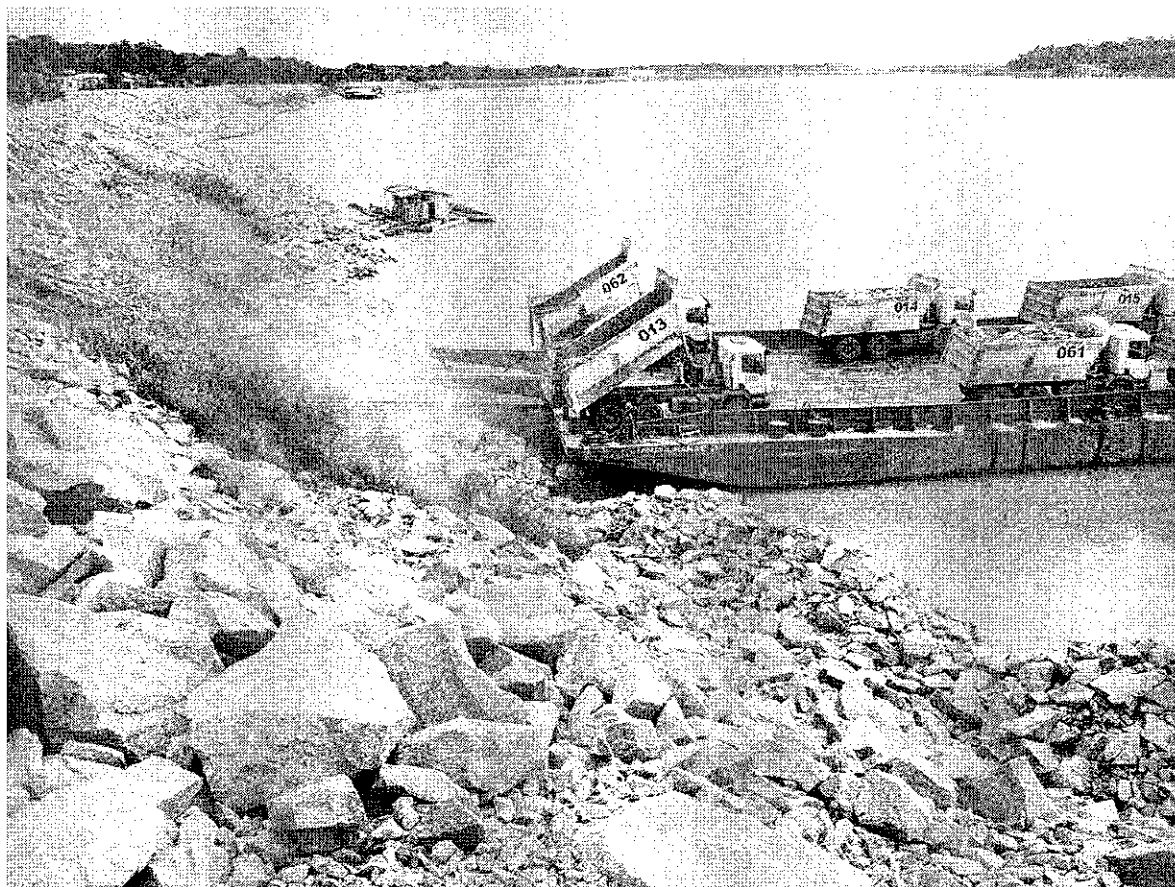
Balça com caminhões basculantes descarregando rochas para construção da berma.
